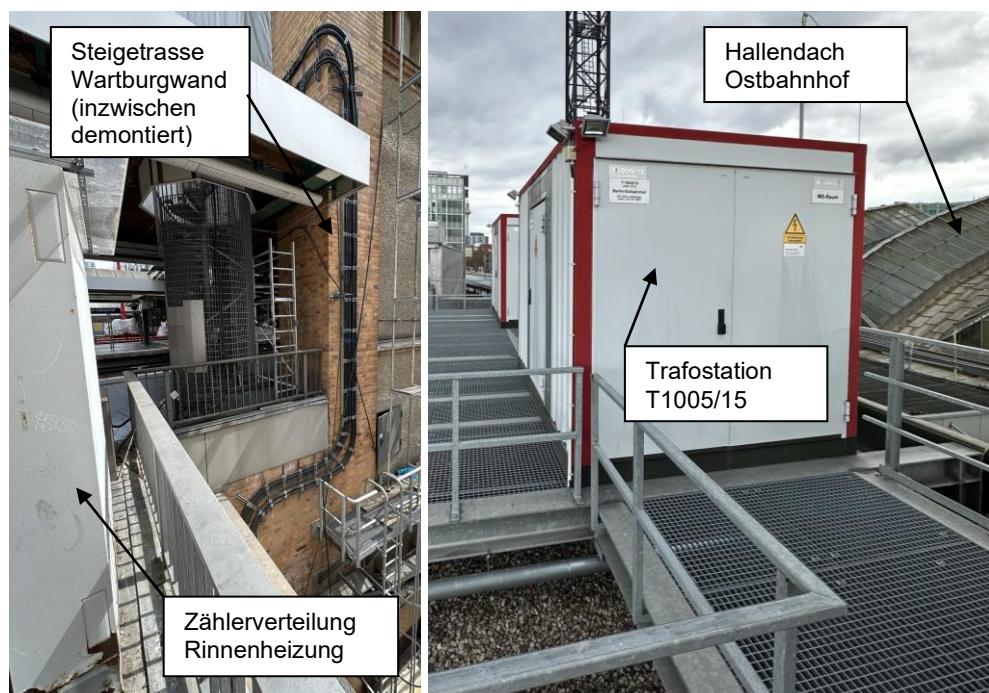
Links: Bahnsteig A mit Blick auf Wartburgwand. Rechts: Dach der Empfangshalle mit Blick aufs Hallendach.
